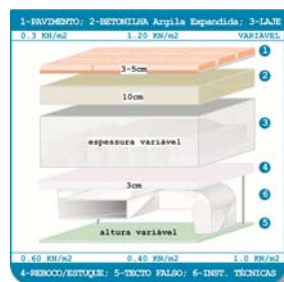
Laje + Tecto Falso Presdouro 10cm Betonilha A. Expandida
